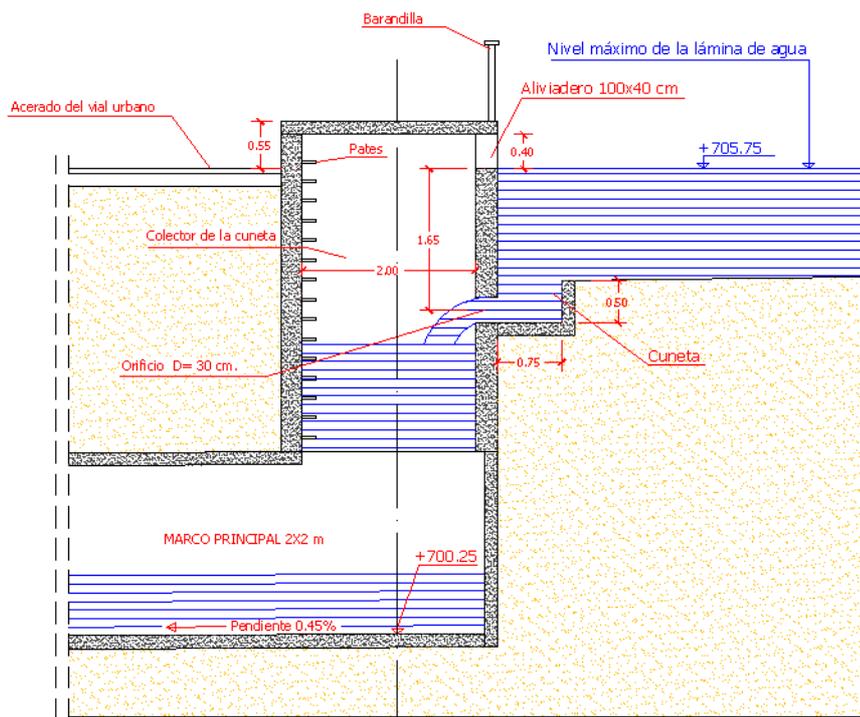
Sección transversal de la obra de captación del arroyo 1 (sin escala)
